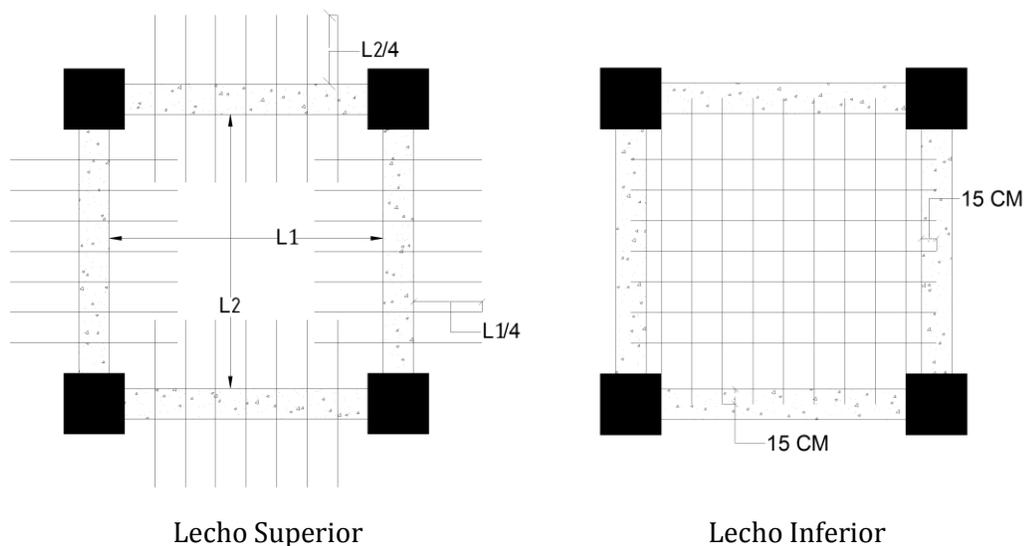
Colocación de acero de refuerzo en losa densa según caso 3
